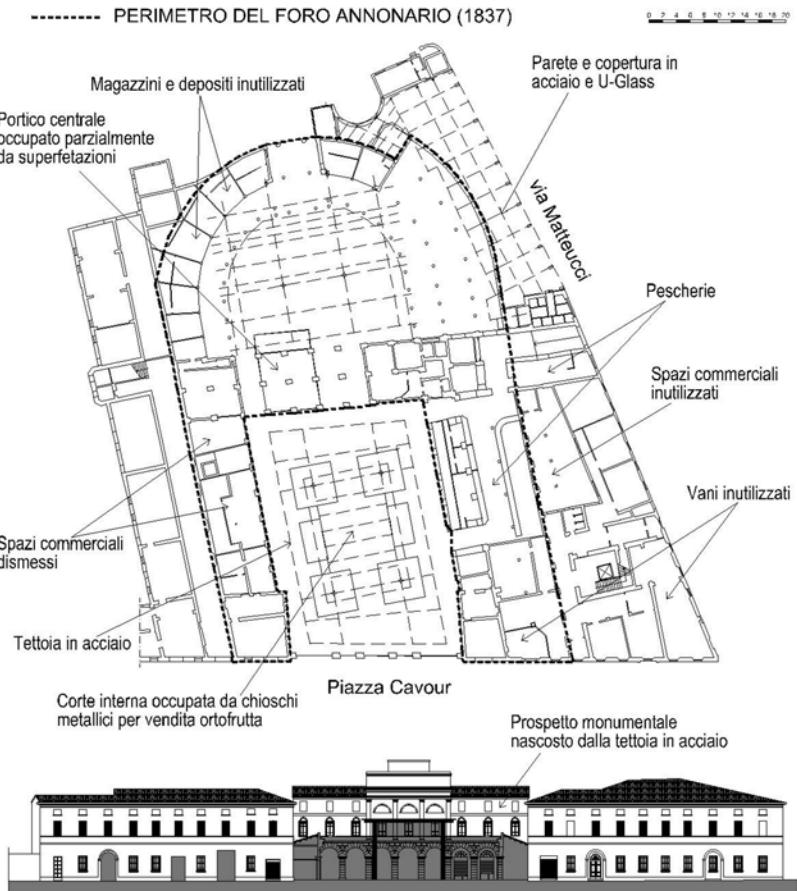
Planimetria e prospetto dello stato attuale, 2015.
